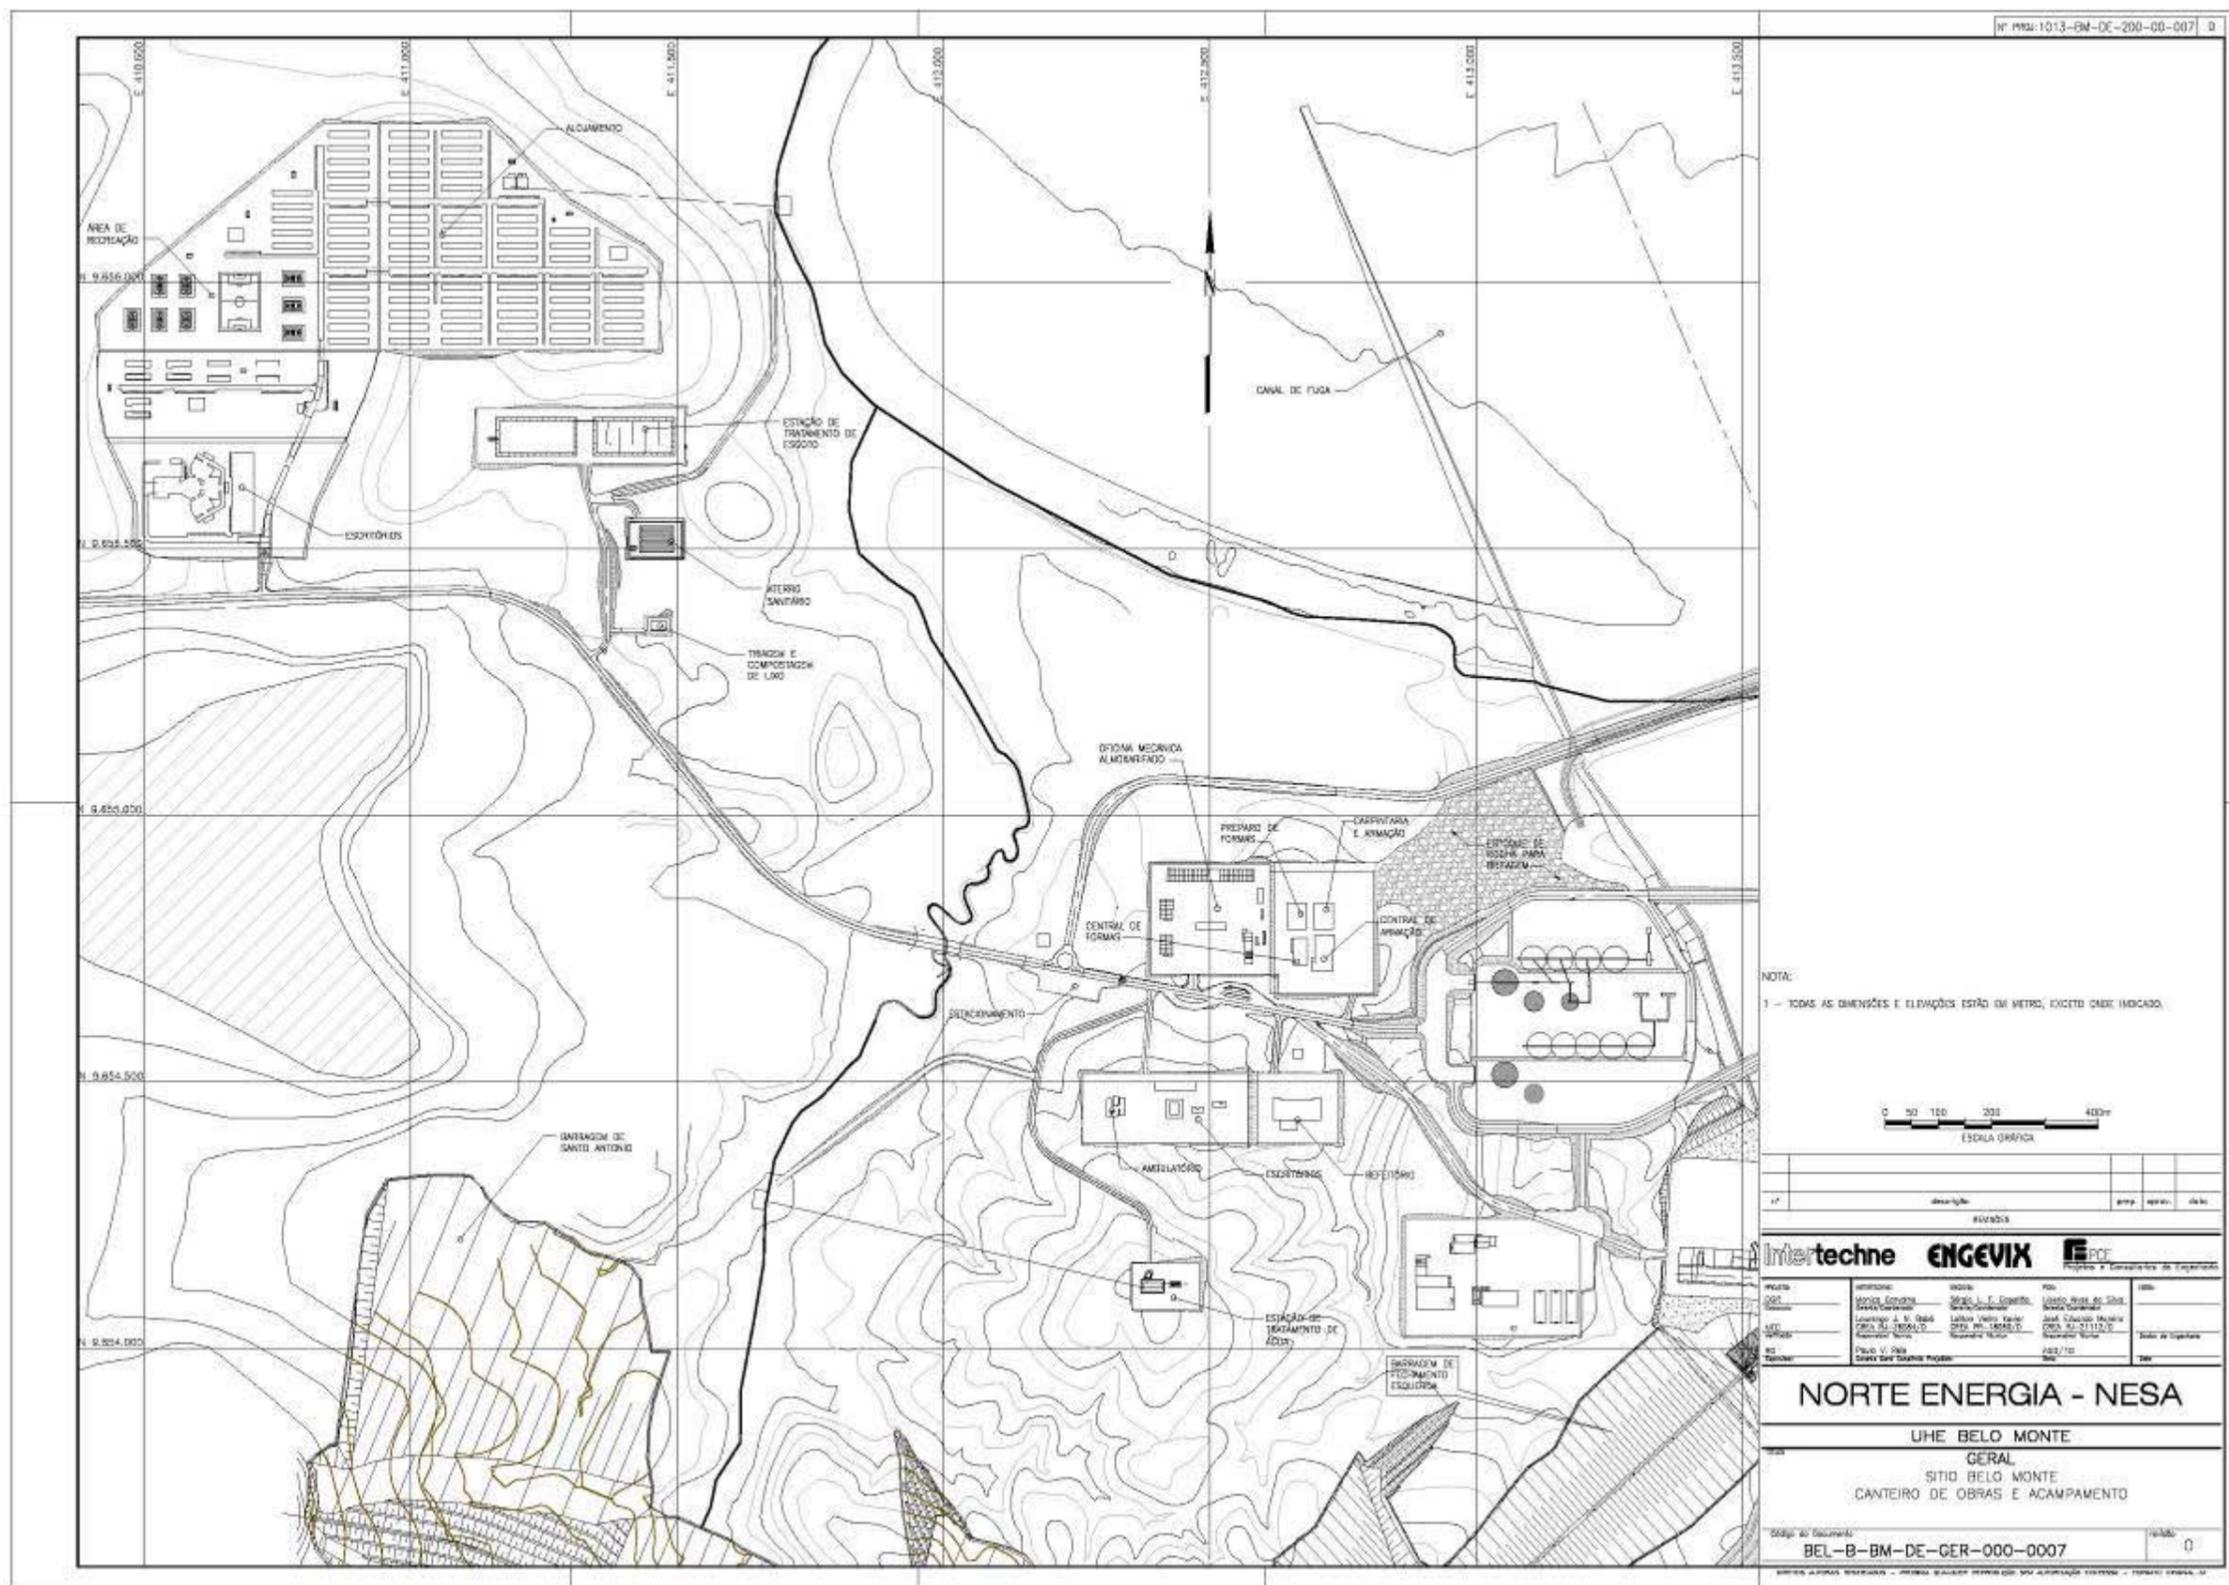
Canteiro de Obras e Acampamento do Sítio Belo Monte
